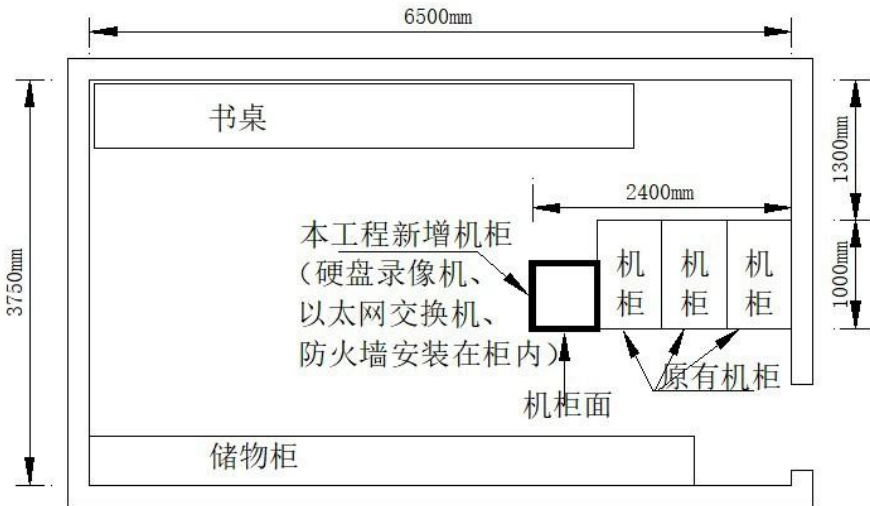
五指山市水务局 2 楼机房设备安装平面图
